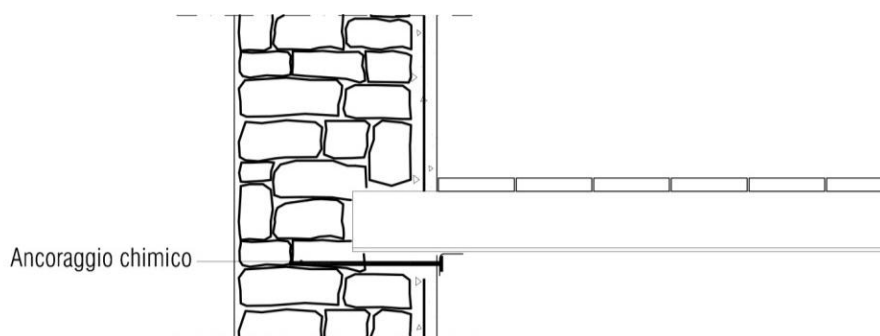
Dettaglio in sezione degli interventi di miglioramento sismico su SOL4
